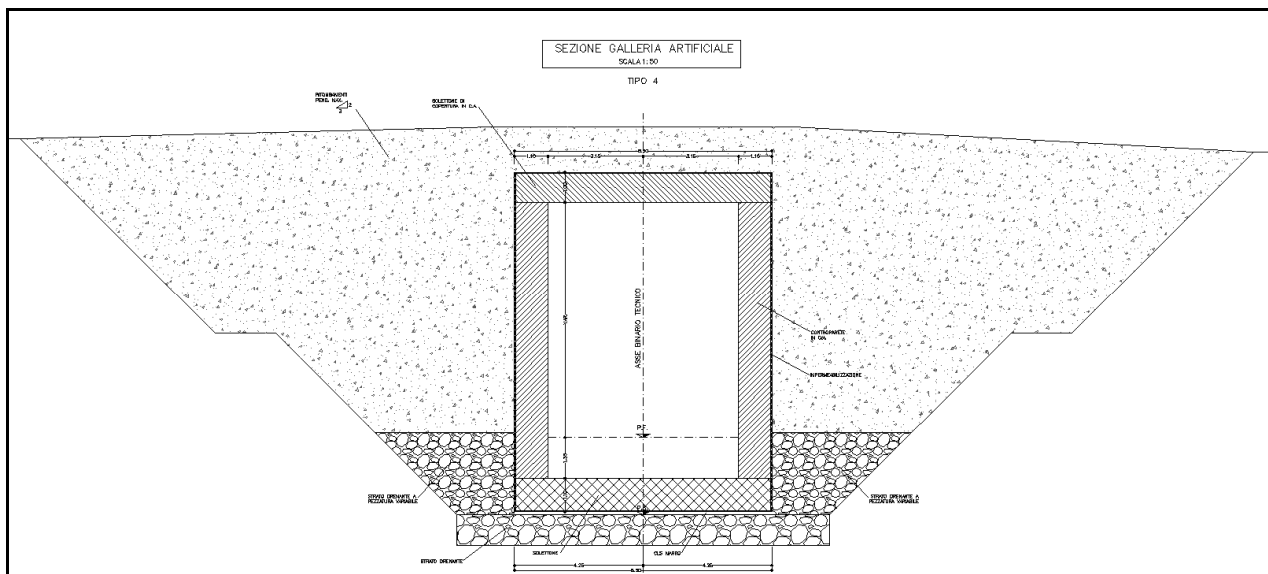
D Sezione tipo Galleria artificiale “Drenante” (sezione tipo “4”)
